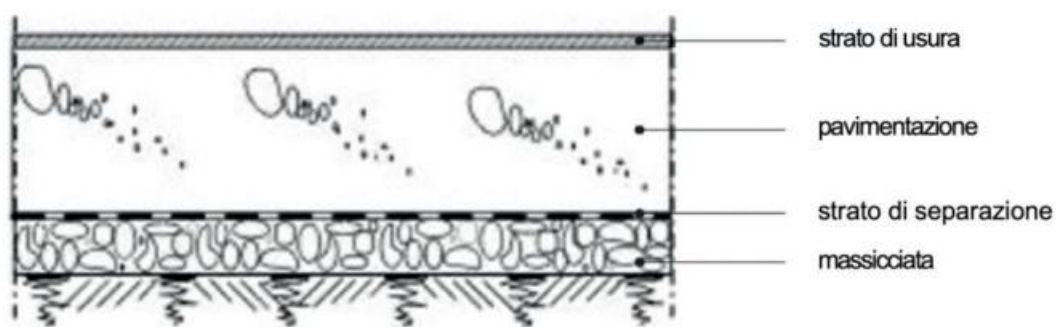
Schema tipo di pavimentazione poggiante su massicciata e terreno
